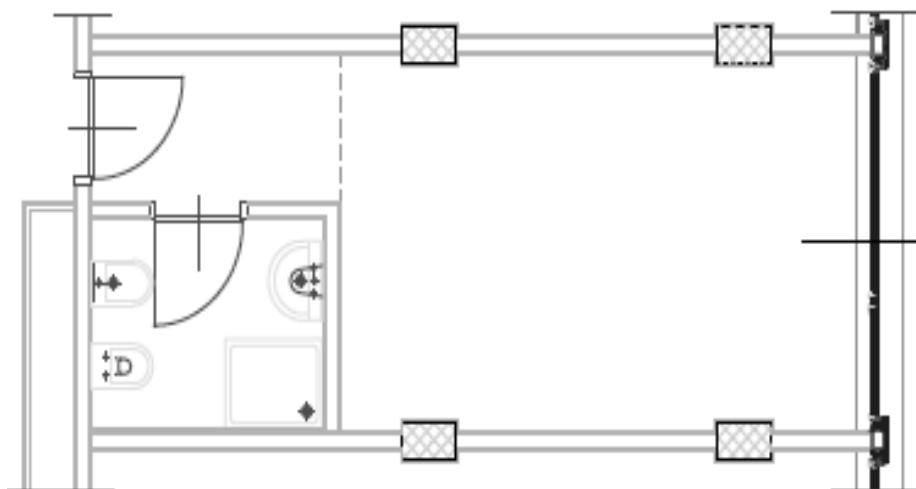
Pianta tipologia Steel - Fonte: archivio In-Domus
